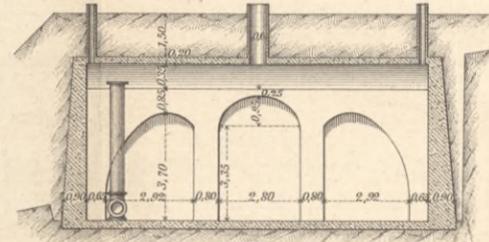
<sup>c</sup> Querschnitt. M. 1:250.
